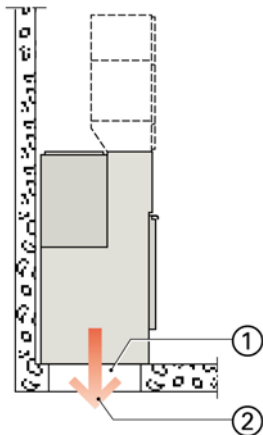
Стандарт: Сброс давления вниз (вид сбоку)
